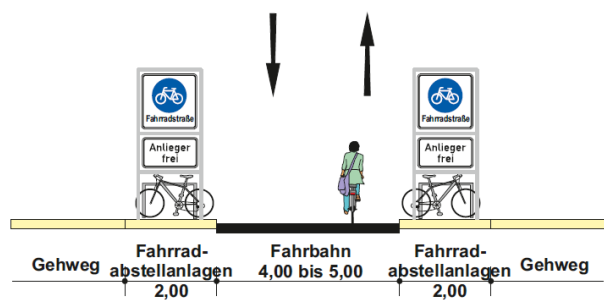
Zufahrten zur Fahrradstraße mit Torsituation
